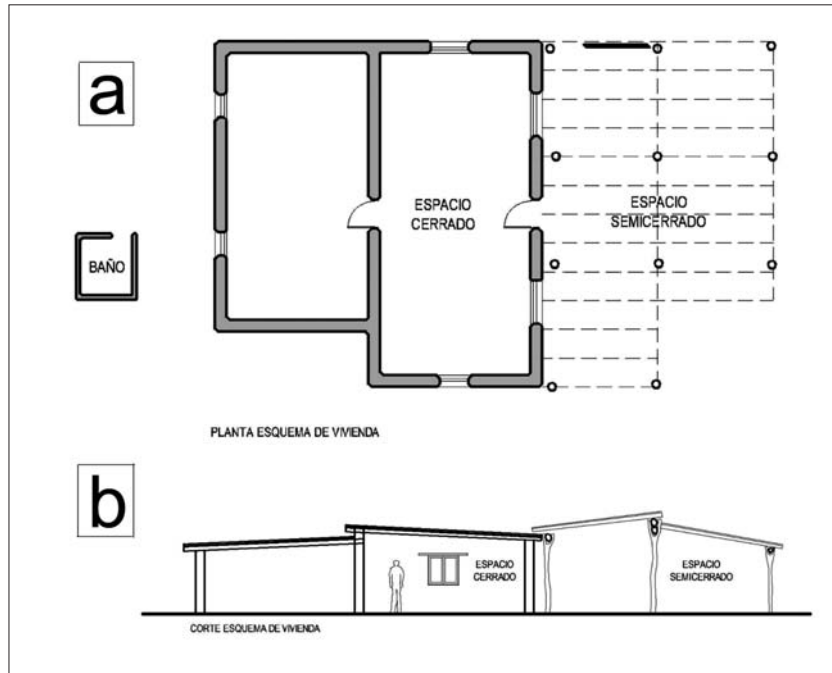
Esquema a) de planta de la vivienda y b) corte de la vivienda.
